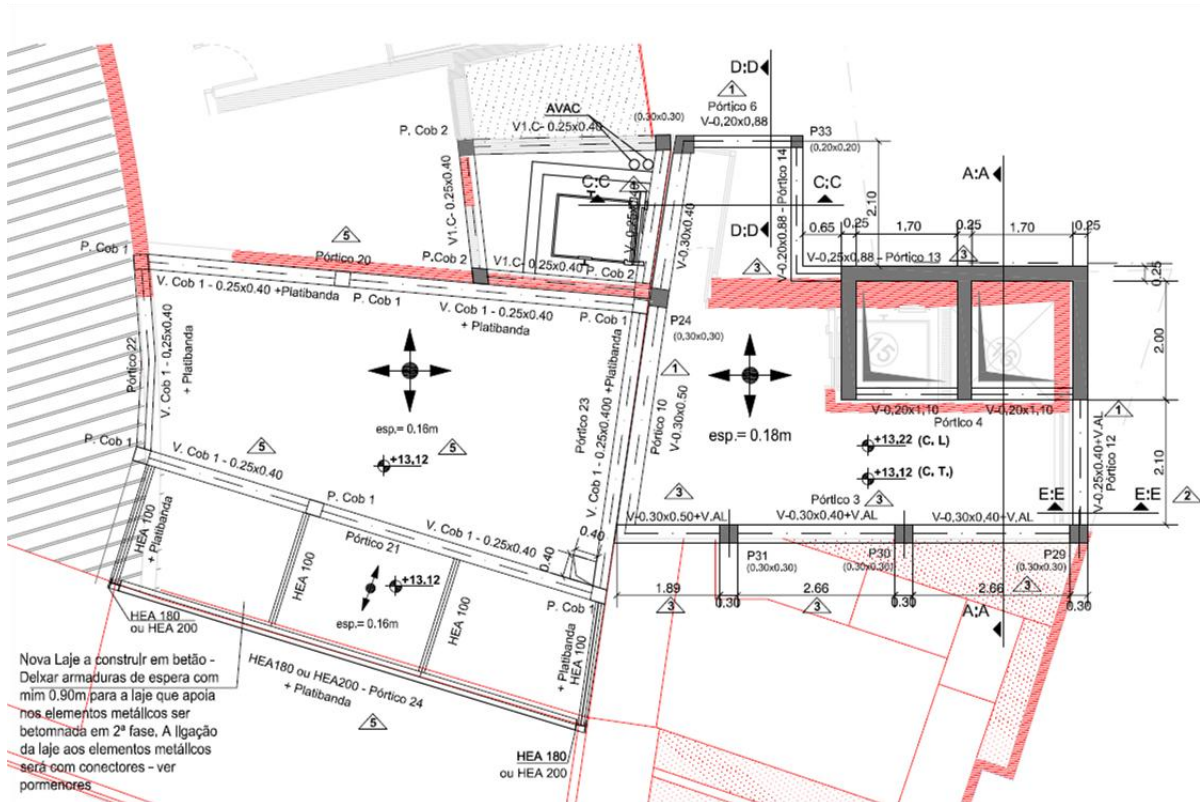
Planta do piso 4 - preparação dos trabalhos [AVicêncio A, 2017]
